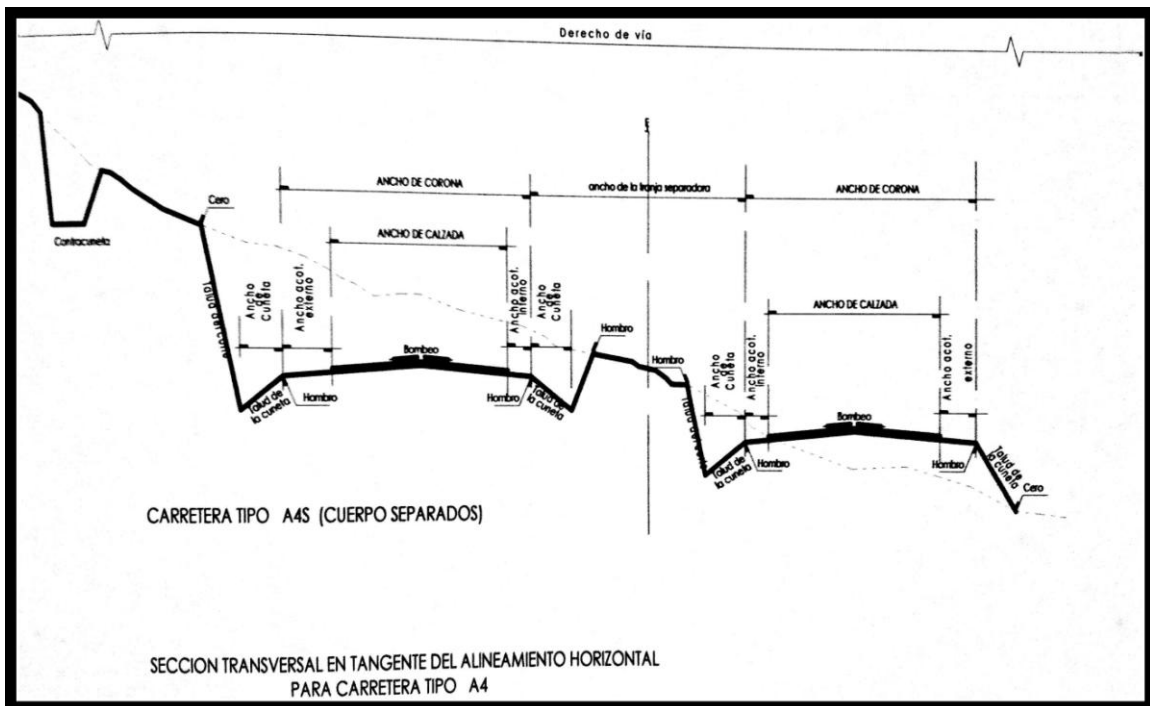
Sección transversal en tangente del alineamiento horizontal para carreteras tipo A4.
